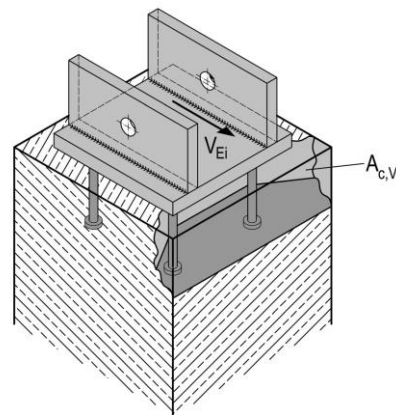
Betonkantenbruch mit 4-seitigem Randeinfluss
